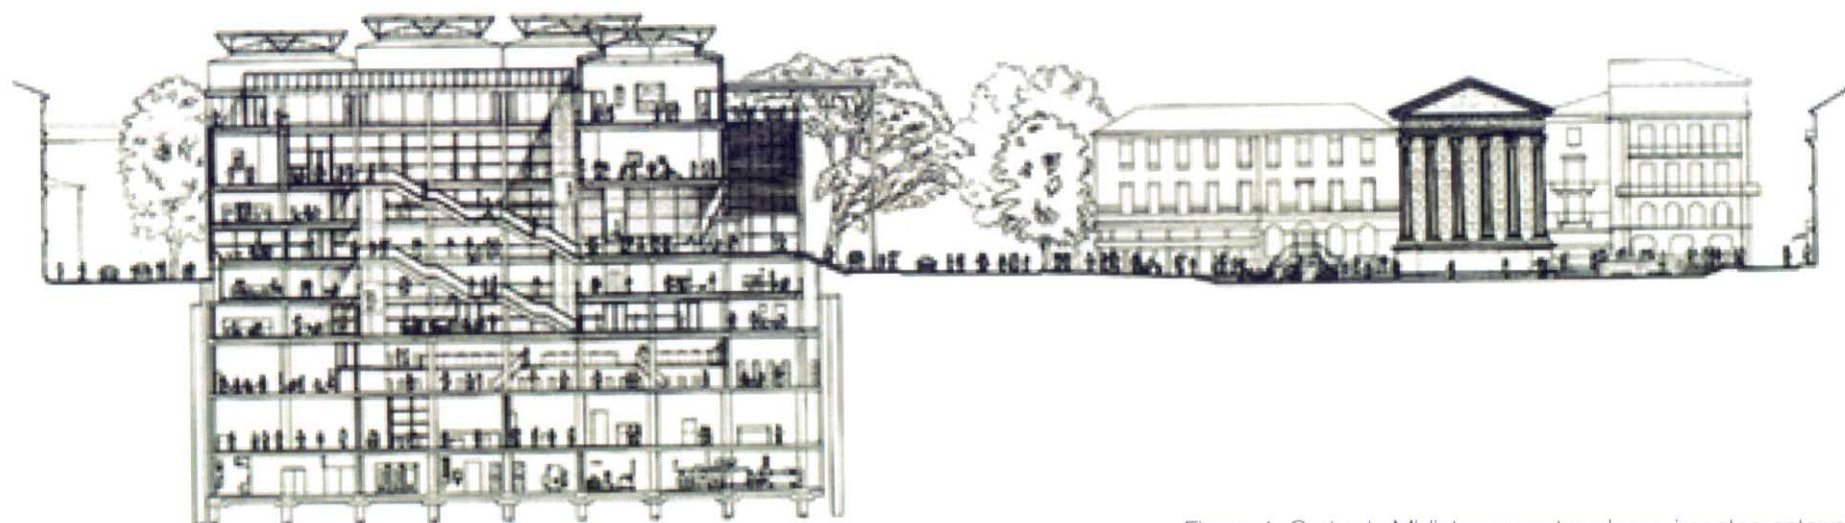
Corte da Midiateca mostrando pavimentos enterrados
